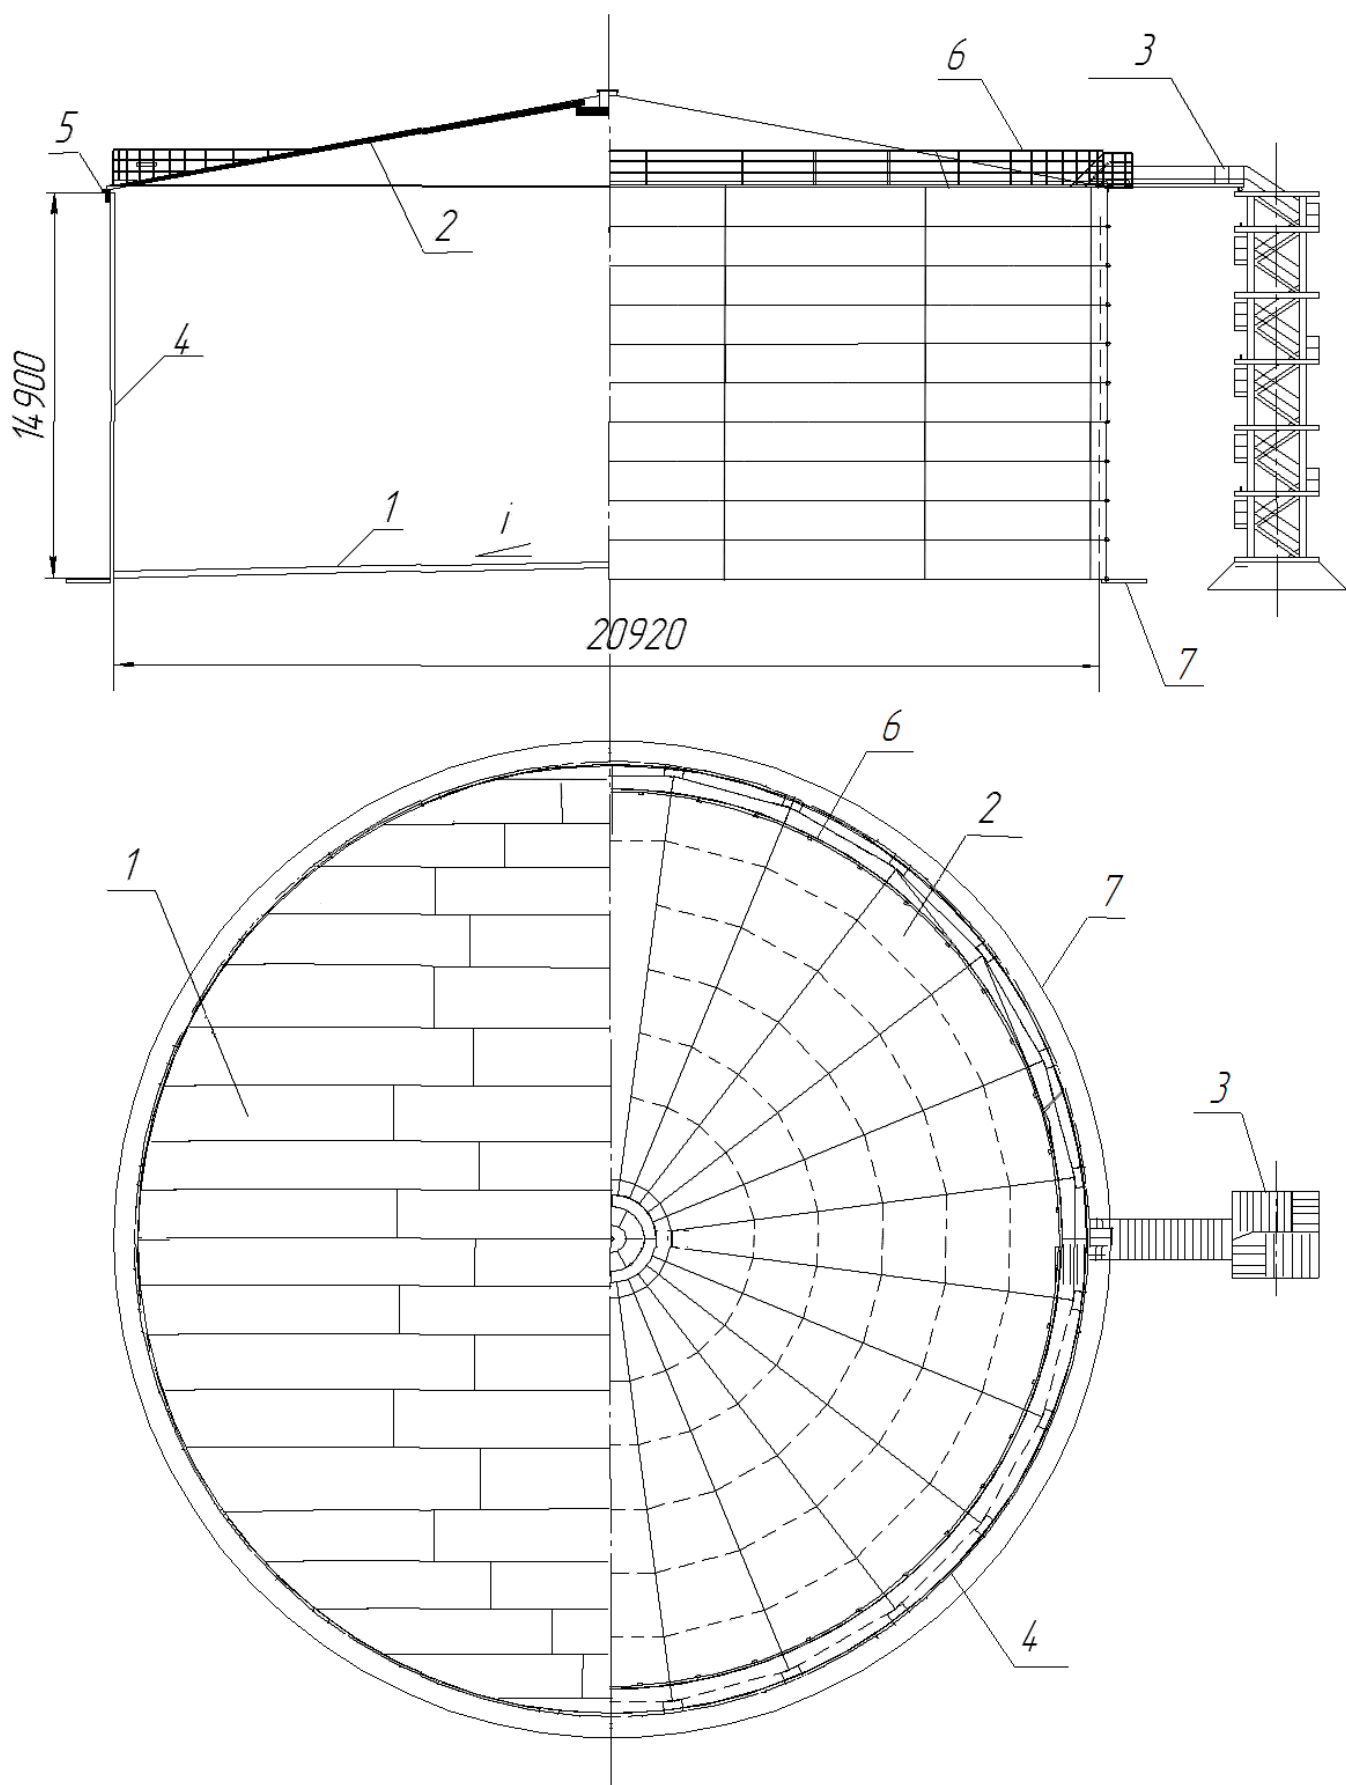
Вертикальный цилиндрический резервуар РВС-5000 серии ТП 704/1 со стационарной конической щитовой крышей:
